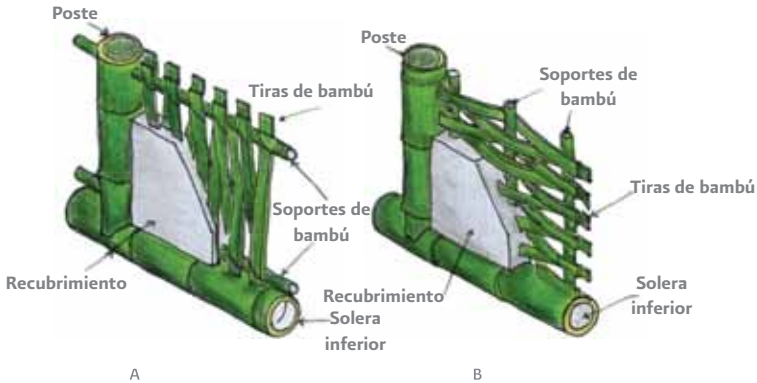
Muro de quincha con tiras de bambú verticales y horizontales.
